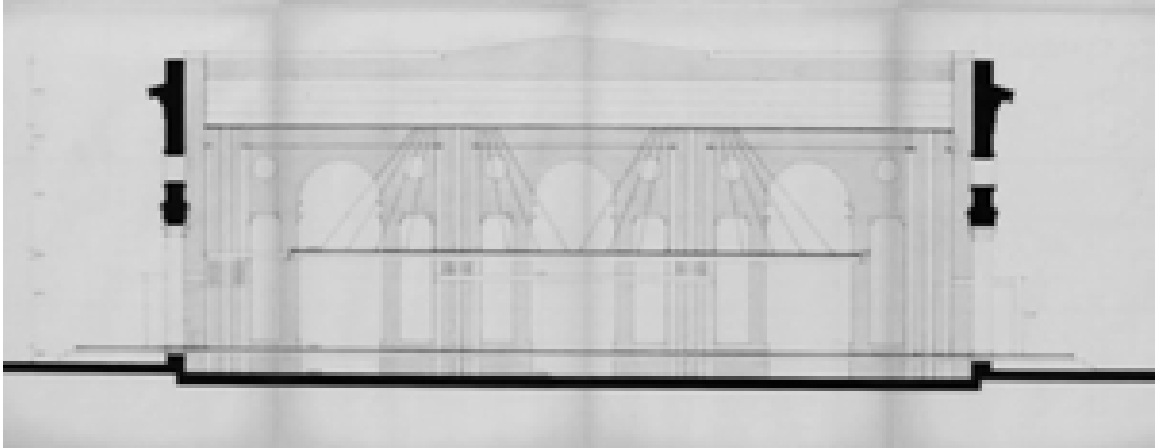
Sezione longitudinale, progetto di massima, 1973/1974 (AABS-163)
